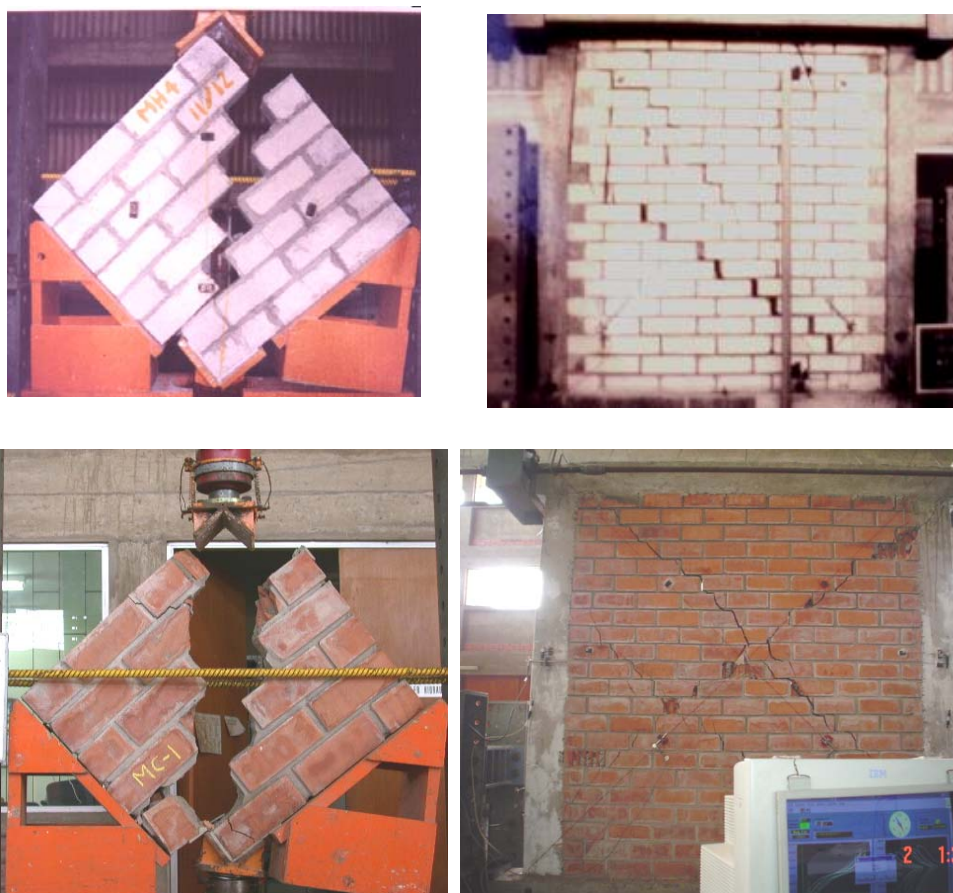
Falla escalonada en murete (izquierda) y en muro (derecha).
